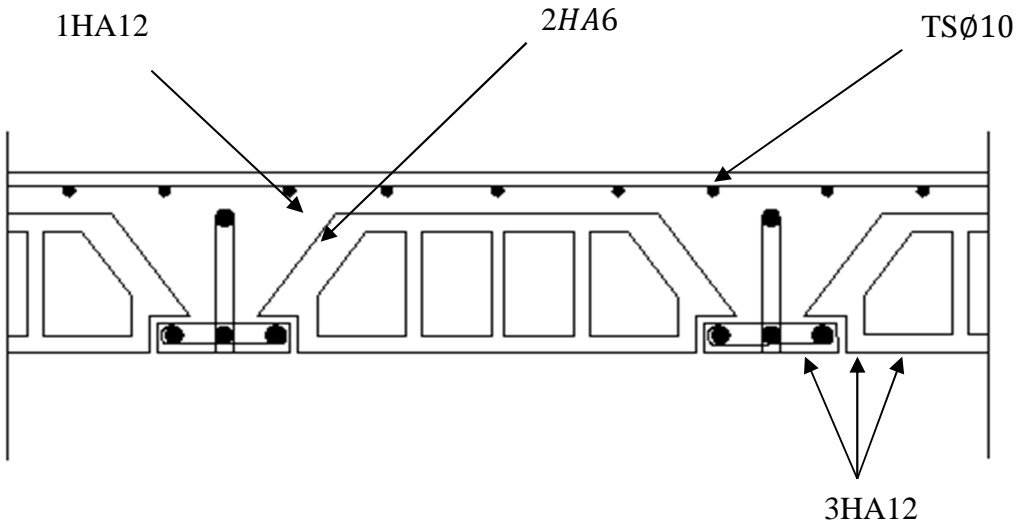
Plan de ferrailage du plancher en corps creux.
